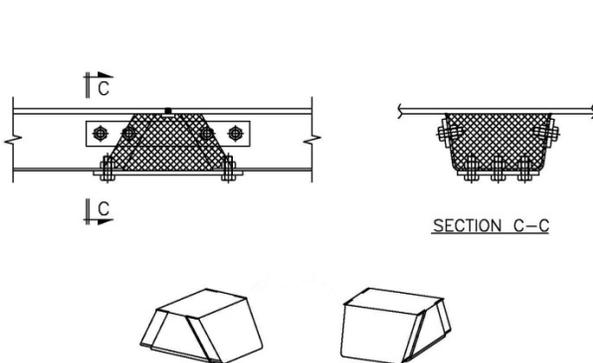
Étanchéité permanente d'auge au point de raccordement
